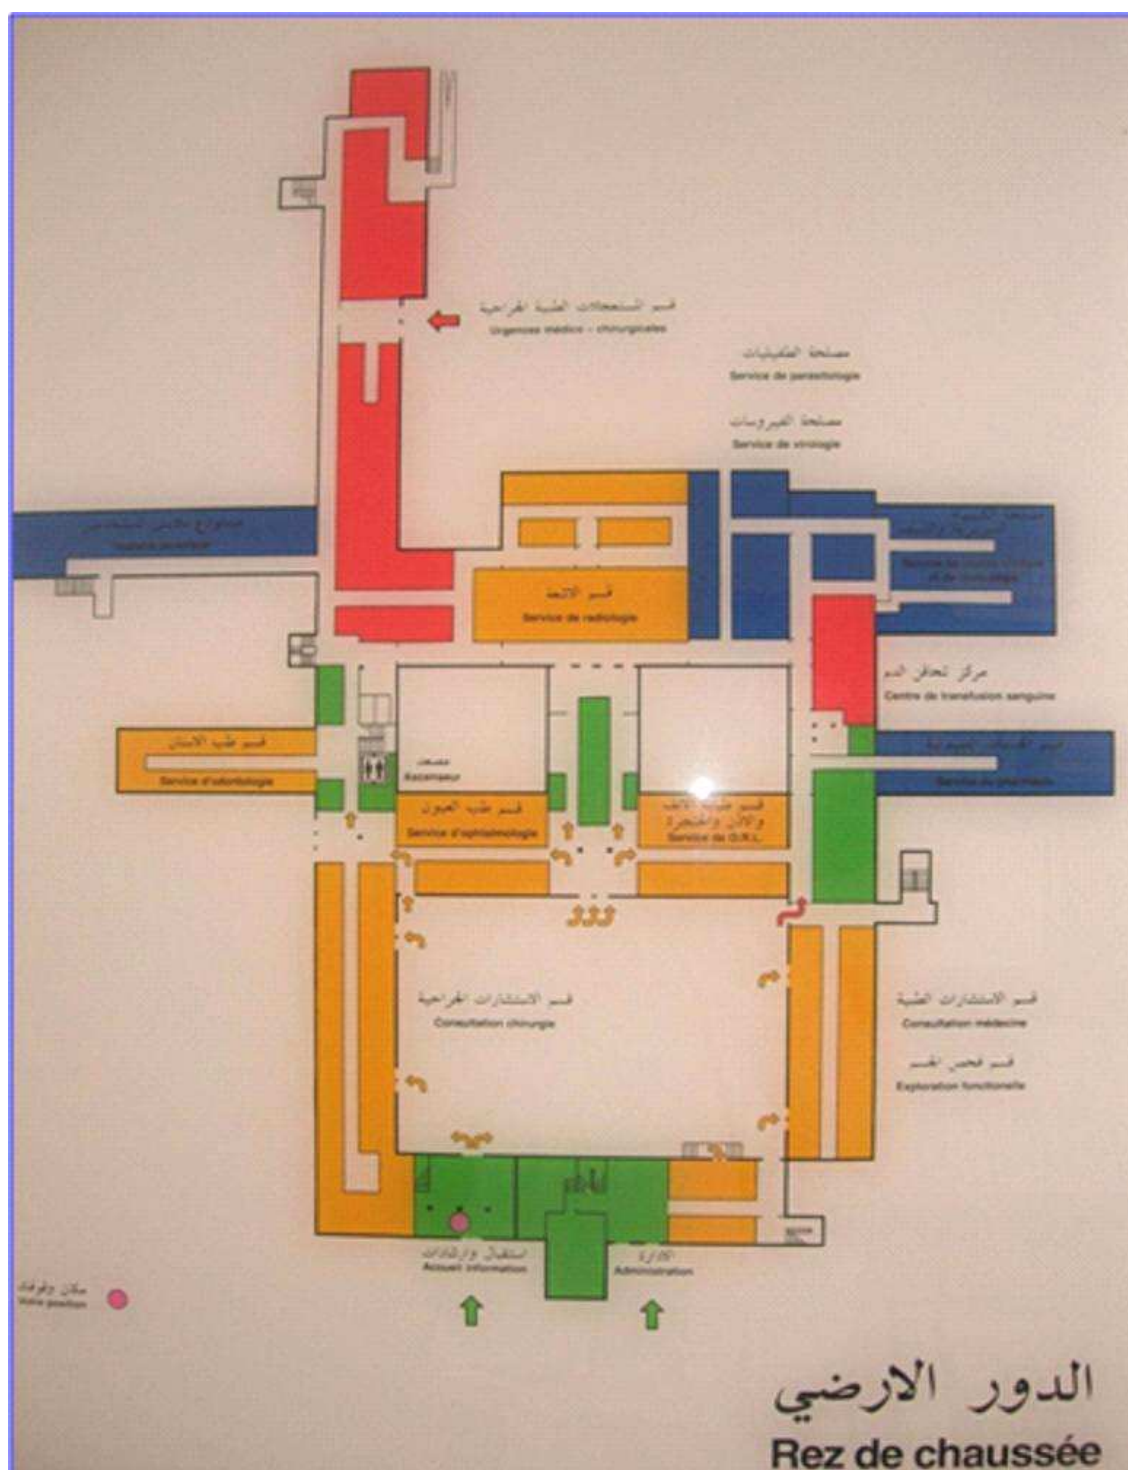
Plan de l'hôpital HMA (Rez de chaussée)
